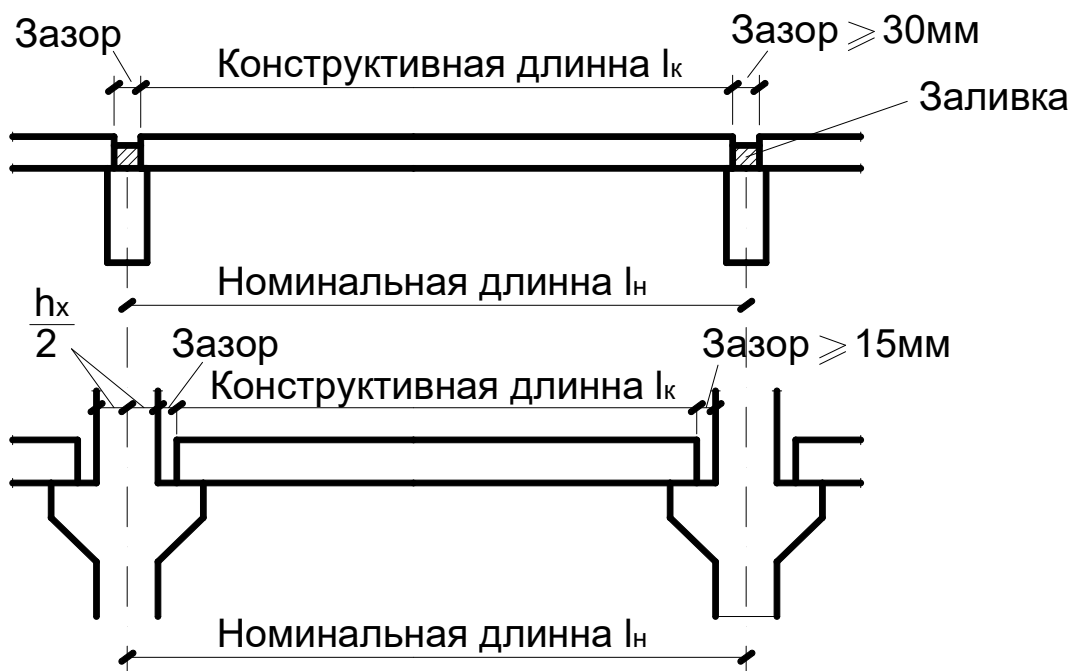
Номинальные и конструктивные размеры сборных элементов: а – панелей; б – ригелей
